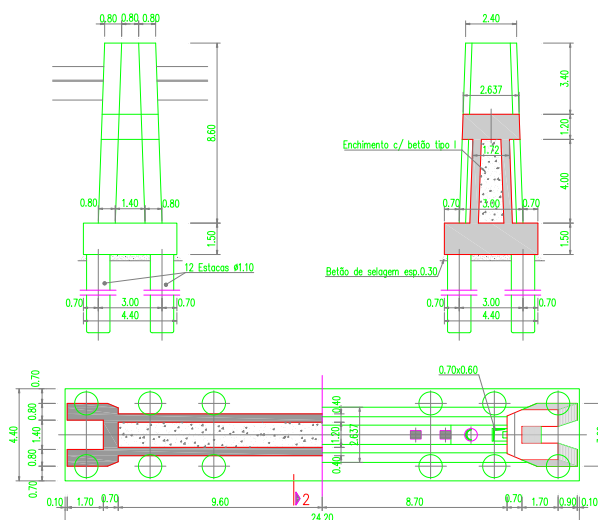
Pilar de Transição da Ponte sobre o Rio Arade
